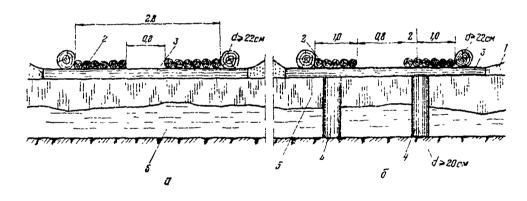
Усиление ледовои переправы устроиством деревянного настила покрытия и основания в виде стоек: 1-снеговой покров; 2-колесопроводы; 3-поперечины; 4-стойки; 5-естественным ледяной покров; 6-вода
